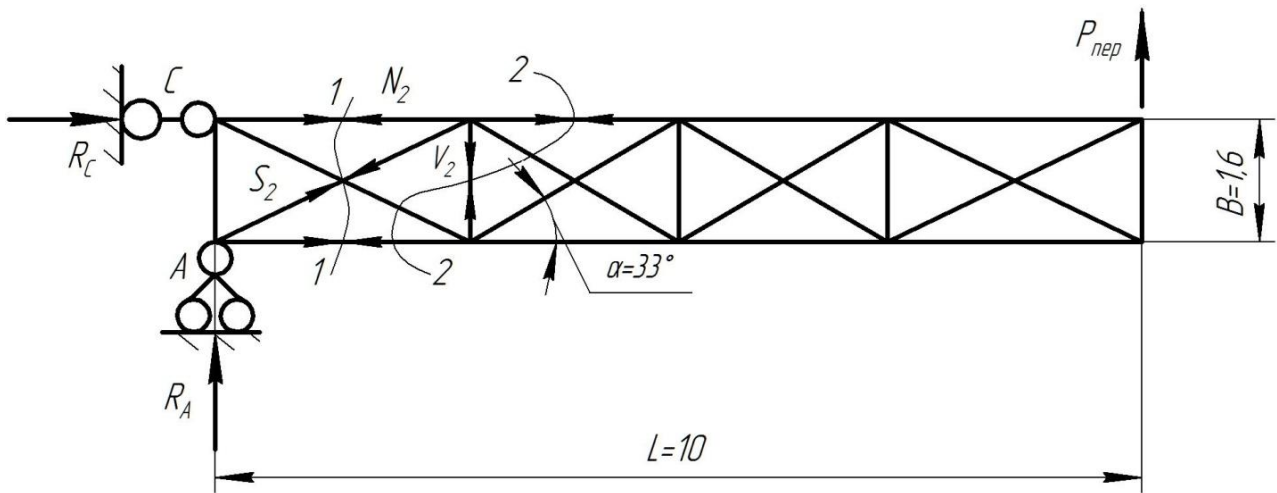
Определение усилий в элементах фермы от нагрузки перекоса
